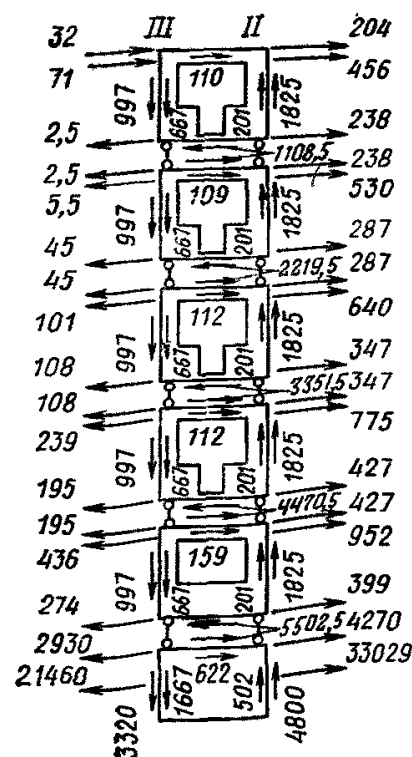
Схема усилий во втором столбце наружной продольной стены (кг)
